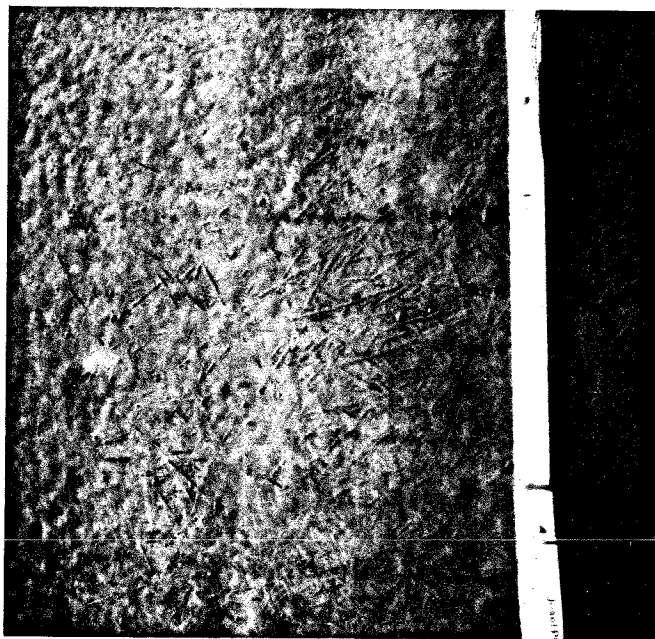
Äußere Oberfläche des Gärfuttersilos
